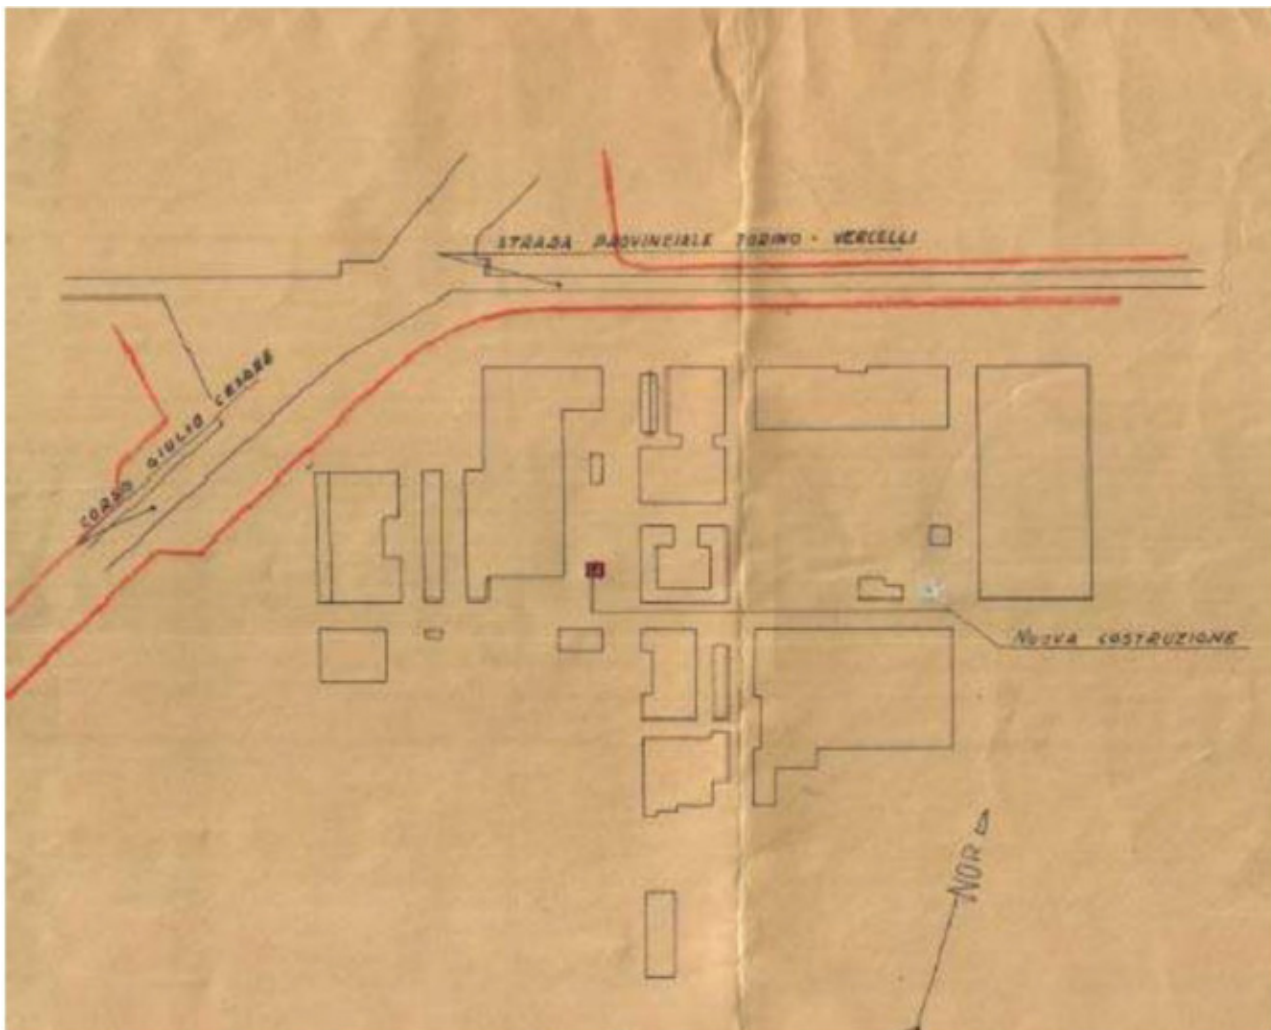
Planimetria catastale 1941 (Fonte dati Archivio Città di Torino)
